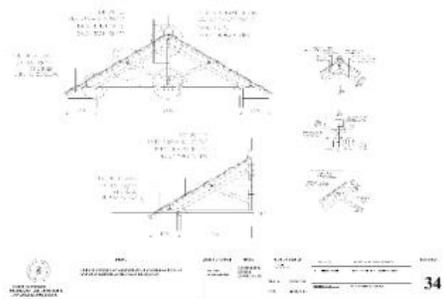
Denah, Tampak, Potongan, Rencana Atap, dan Pondasi
